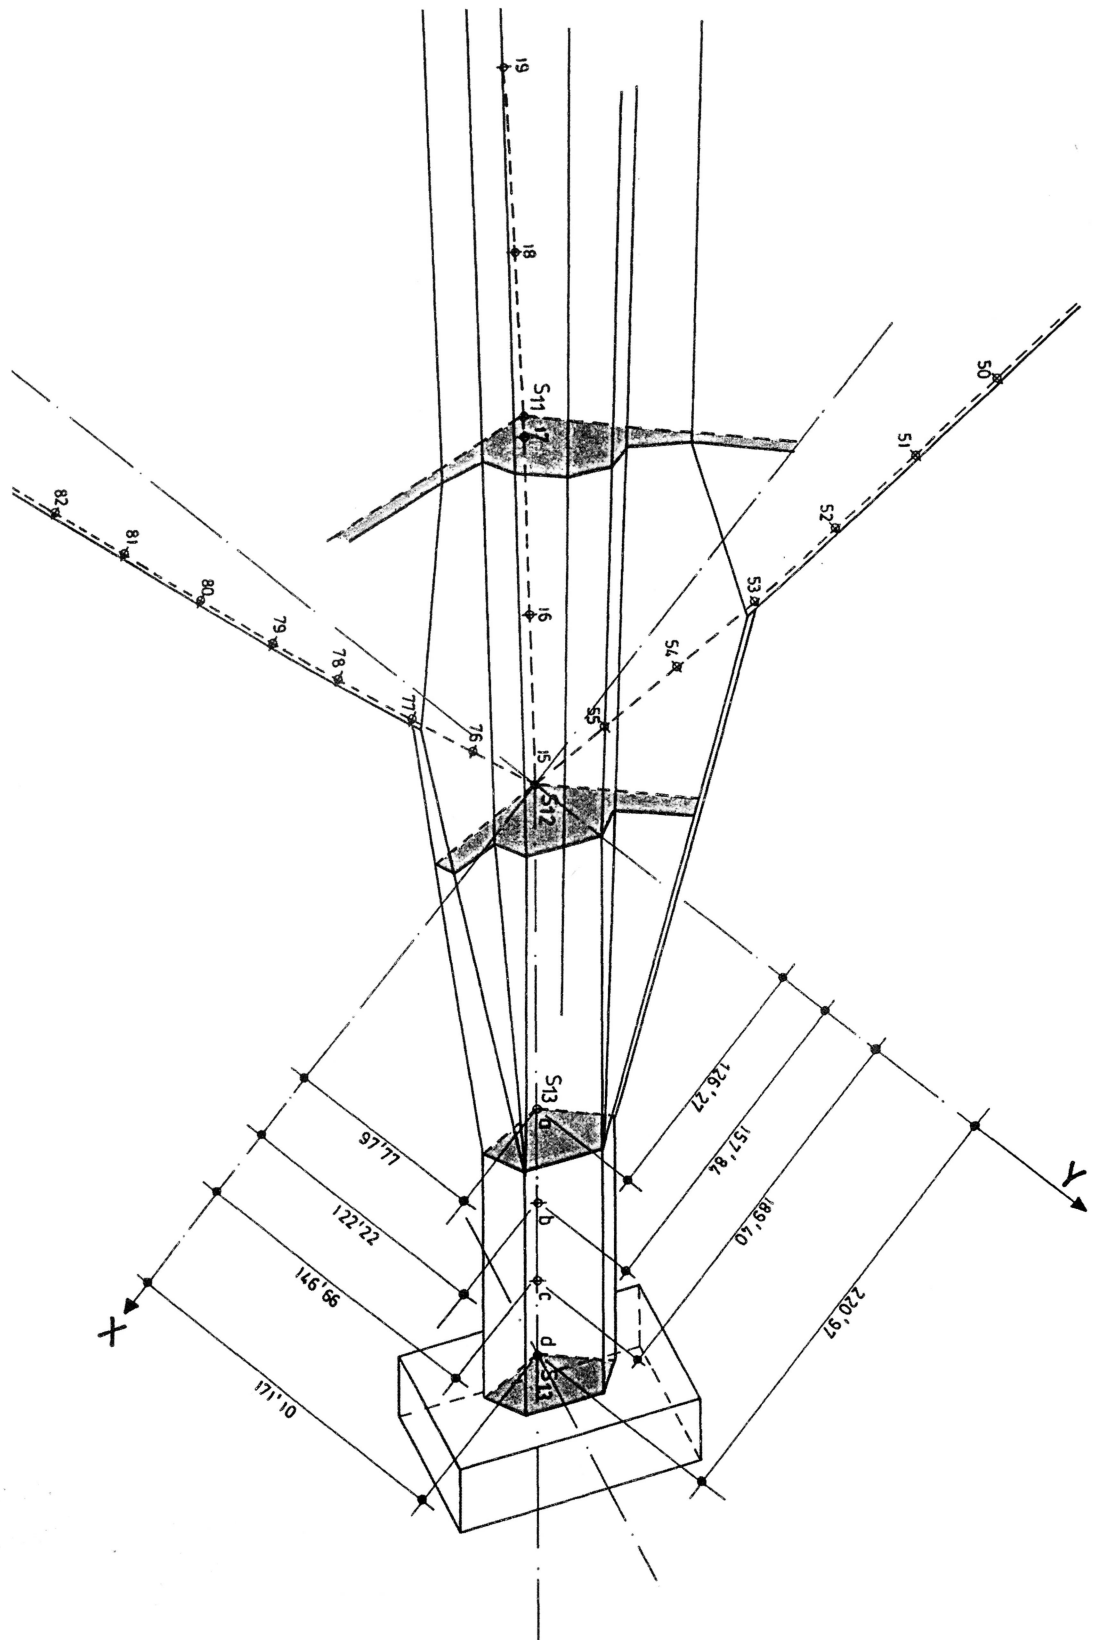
Cubierta de vestíbulo. Apoyo lateral (Detalle).
